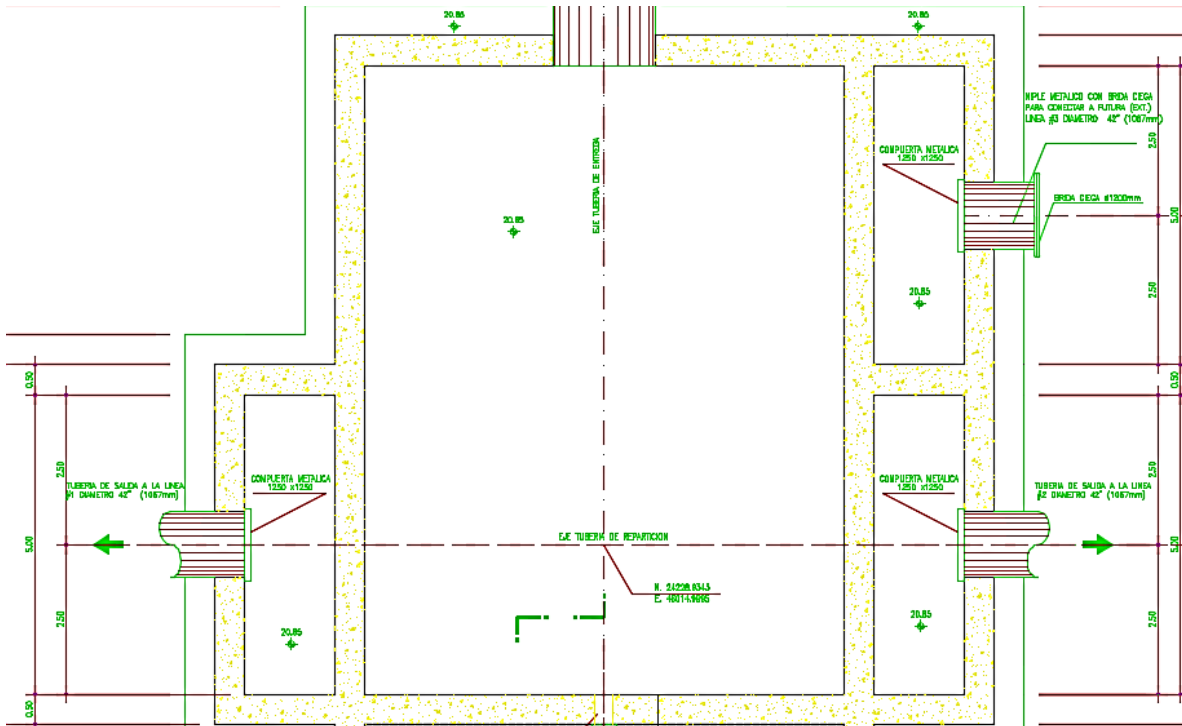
Vista en planta de Caja de Entrega de la P.T.A.P de Barrera de Salinidad
